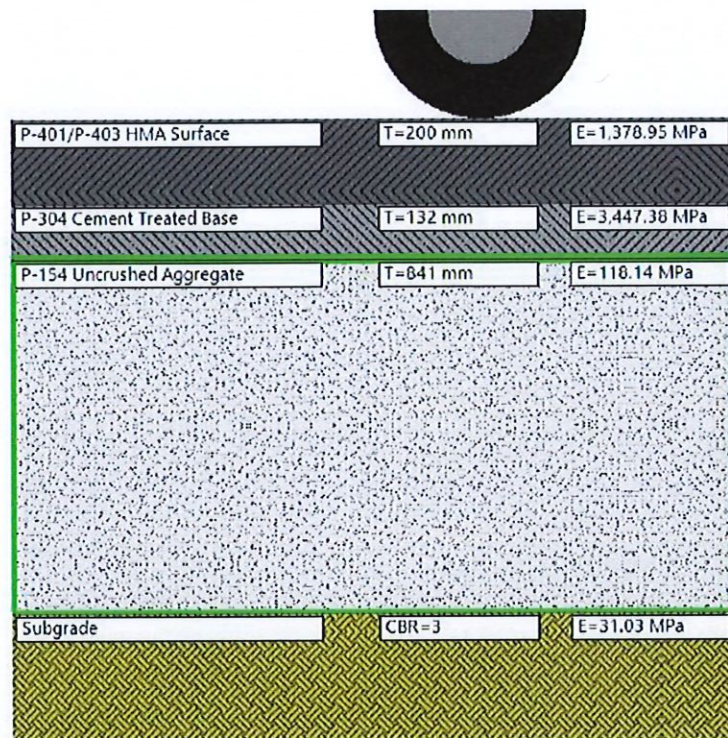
Resumen estructura de pavimento flexible con base estabilizada con cemento.
